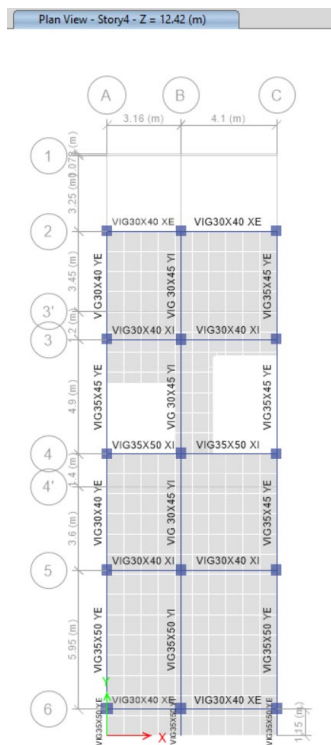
Distribución final de elementos estructurales en la PLANTA 4
